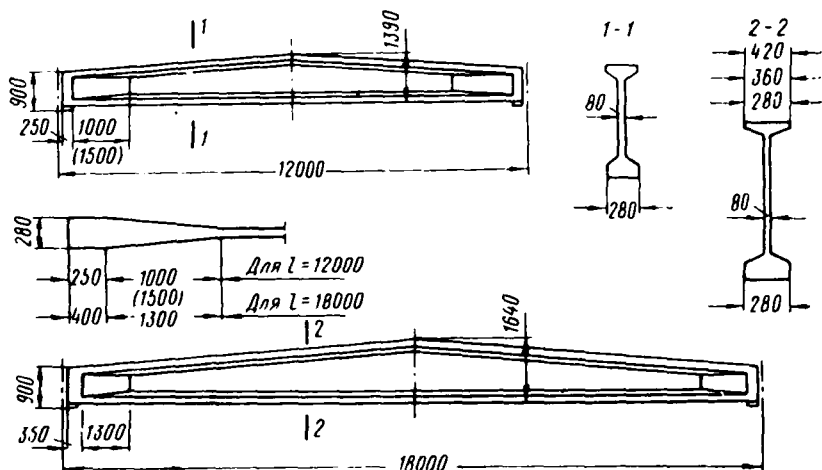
Опалубочные размеры новых двутавровых балок пролетом 12 и 18 м
